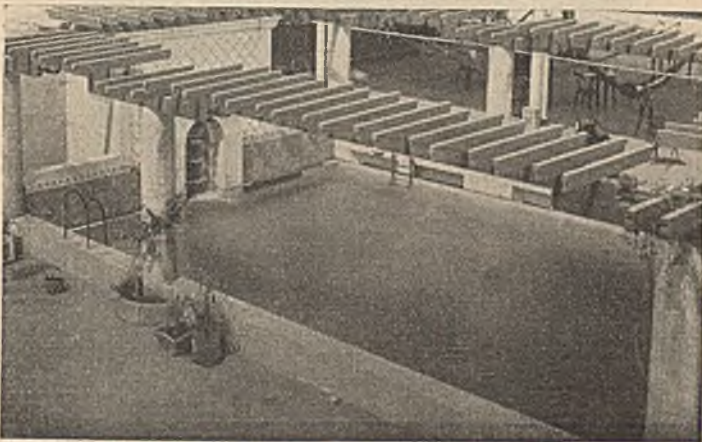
Gebäude der Buick-Agentur: Das in dem flachen Dach des III. Stockes eingebaute Schwimmbecken. — Der schmale dunkle Streifen an der Wasseroberfläche rührt von heruntergefallenen weißen Emailplättchen her.
